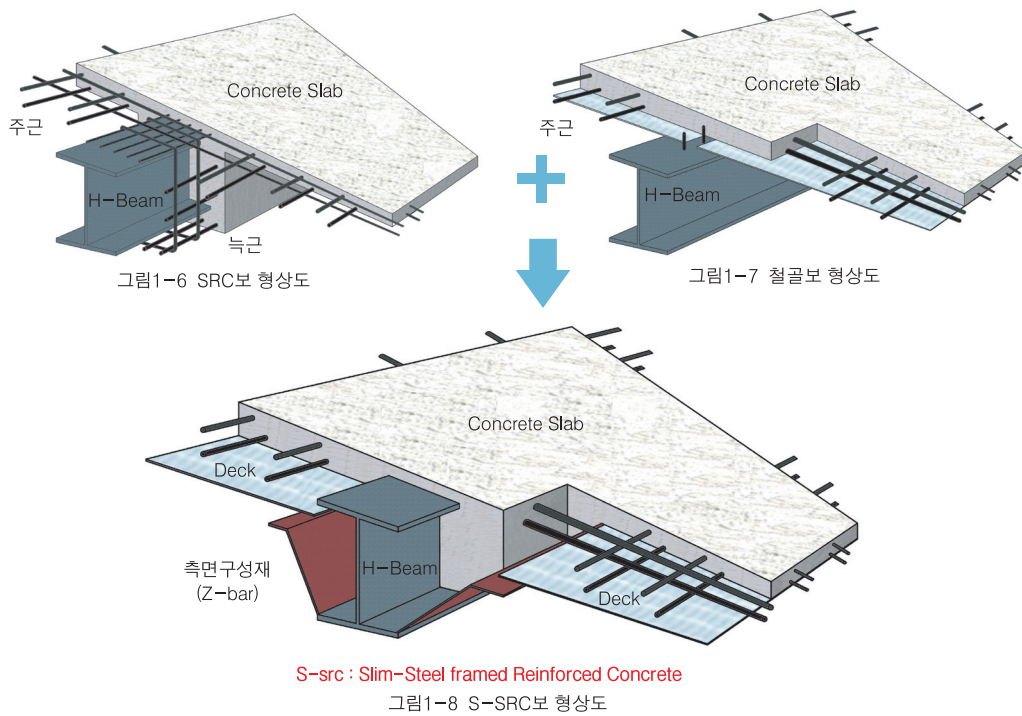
S-SRC(Slim Steel framed Reinforced Concrete)공법은 형상과 성능에서 그림1-6 SRC(Steel framed Reinforced Concrete)공법과 비교하면 S-SRC공법은 SRC공법에서의 거푸집 대응으로 측면구성재를 사용한다.
